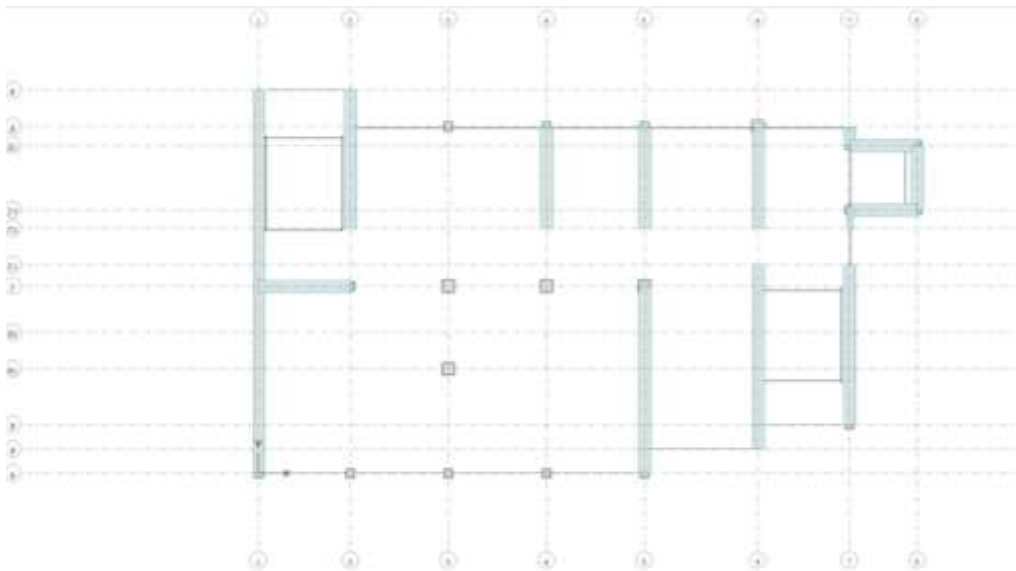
Креслення опалубочне плити монолітної залізобетонної
